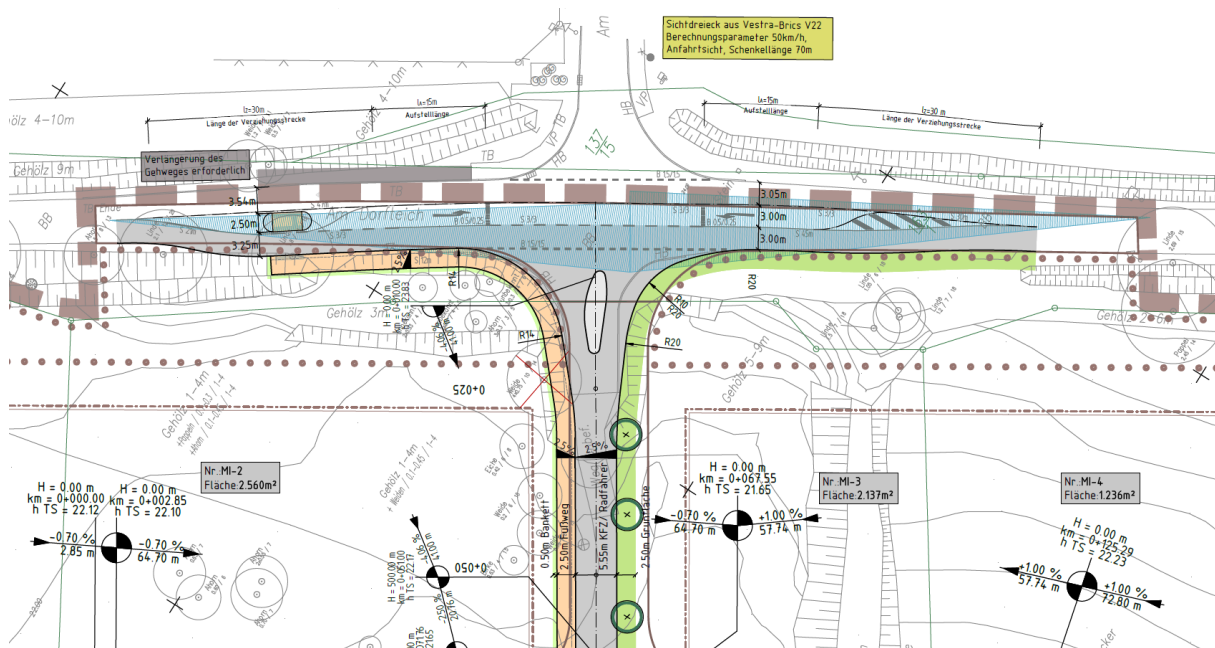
Lageplan Straßenbau - Variante B, Vorplanung (Merkel Ingenieur Consult, Bad Doberan, 10.02.2023)
